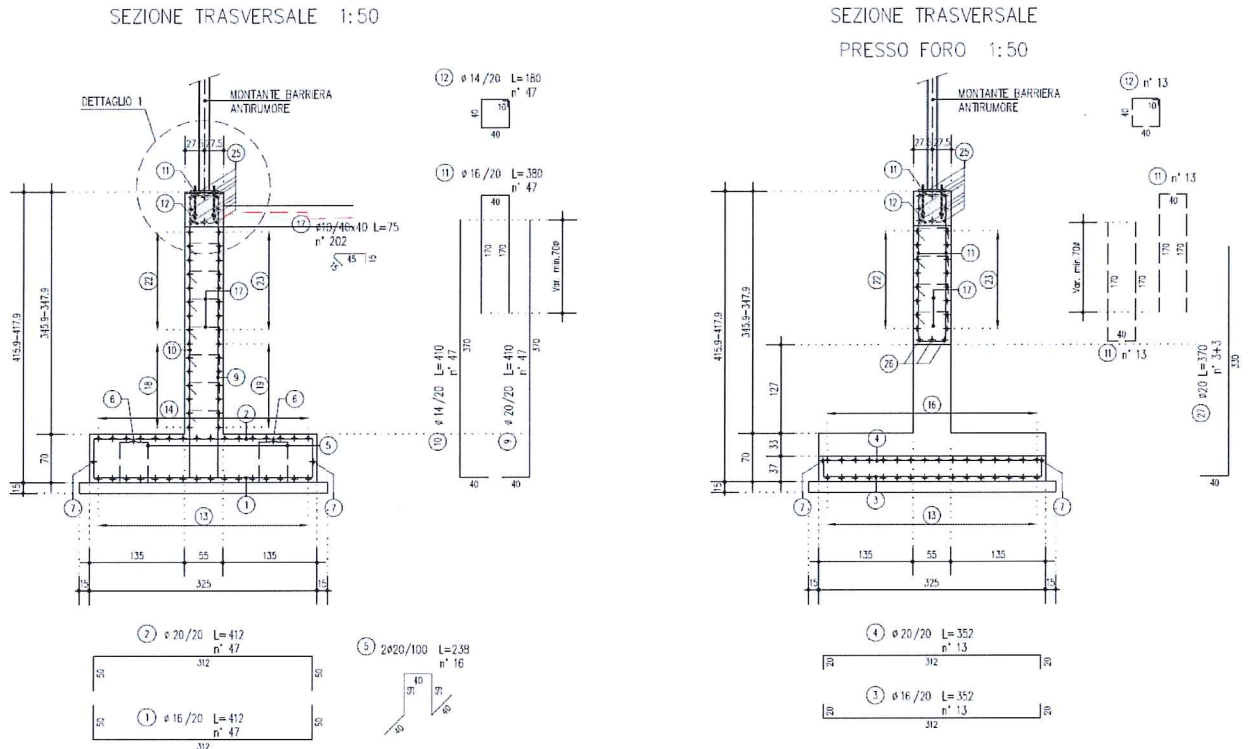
Schema armatura – Muro tipo 4 –Concio 25
